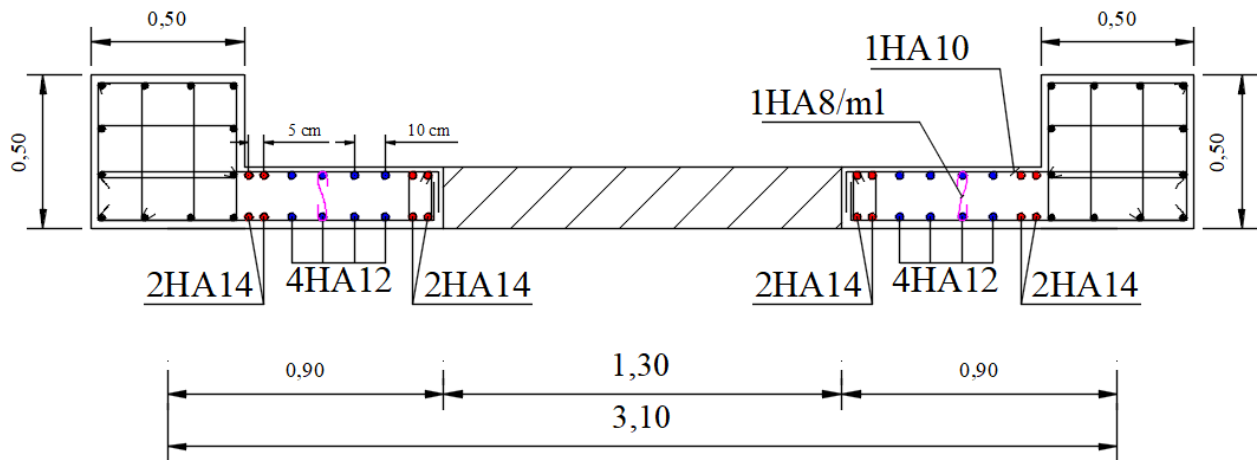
Schéma de ferrailage du trumeau VL1.
